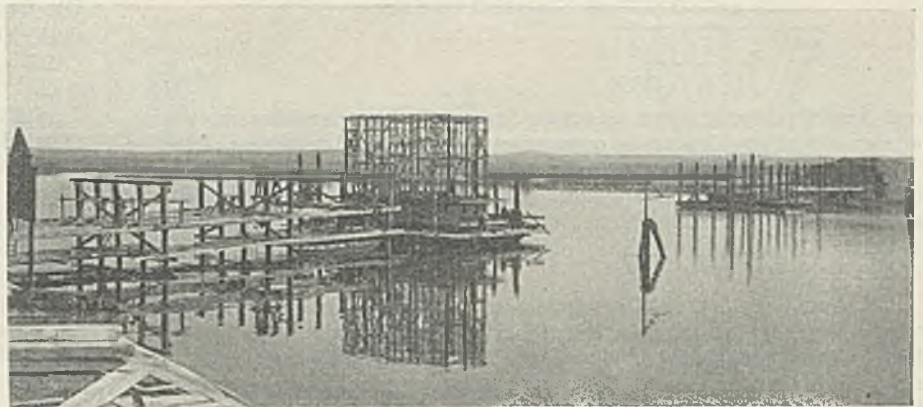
Schalungsgerüst für das aufgehende Pfeilermauerwerk vor dem Absenken.
